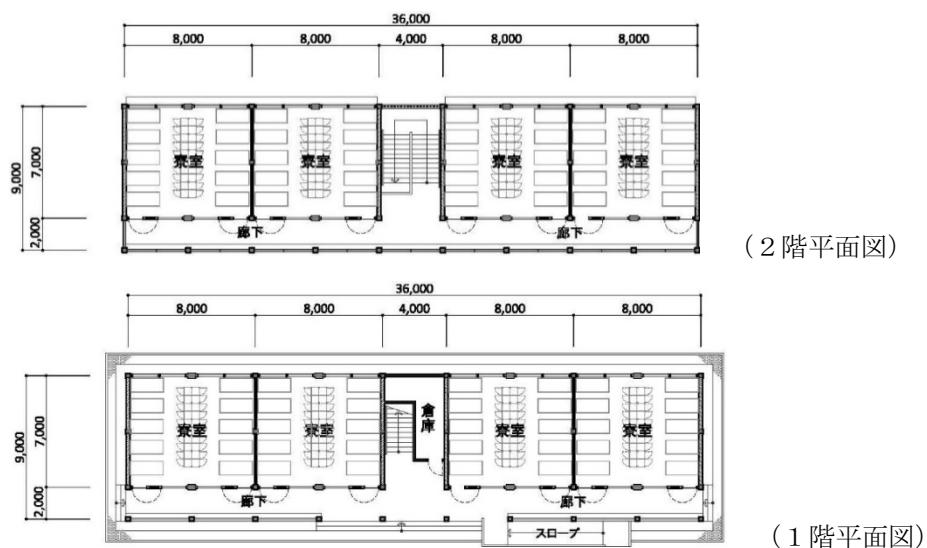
TTC 本体・学生寮平面図 (PKS TTC)
